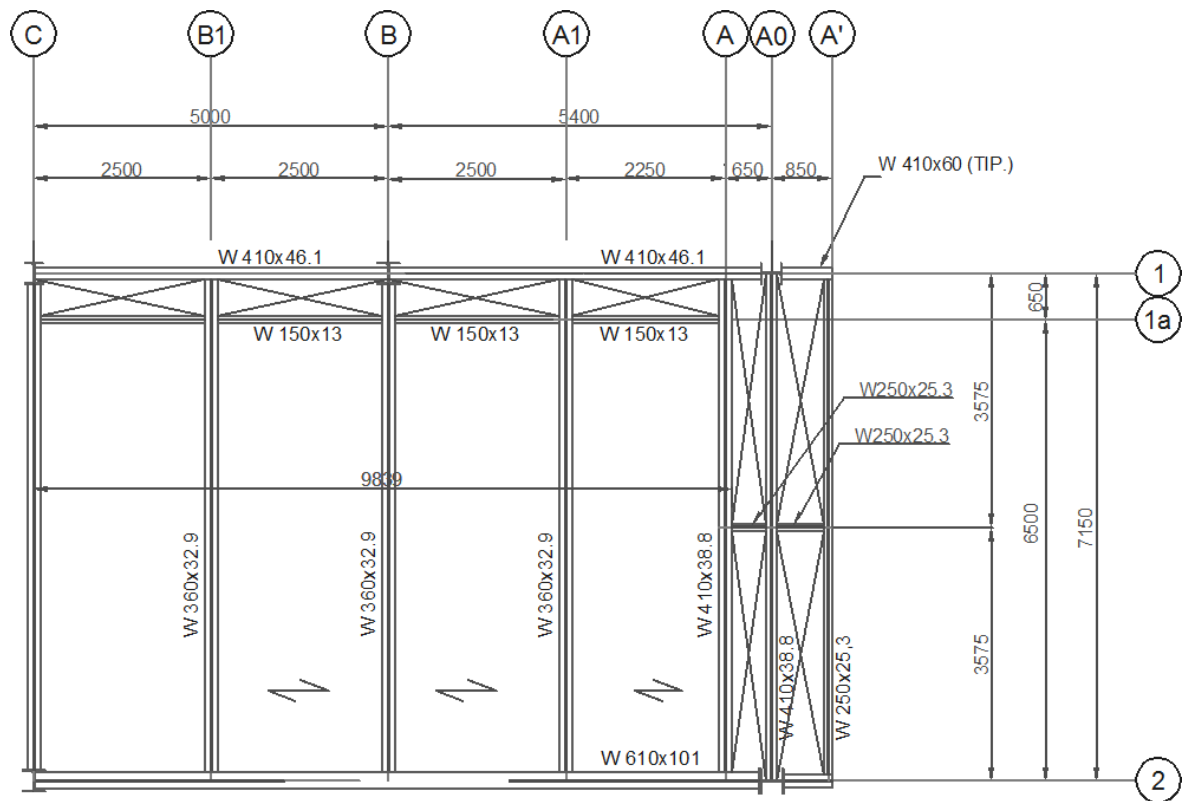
Planta de Elevação Nível + 0 até 2800.
